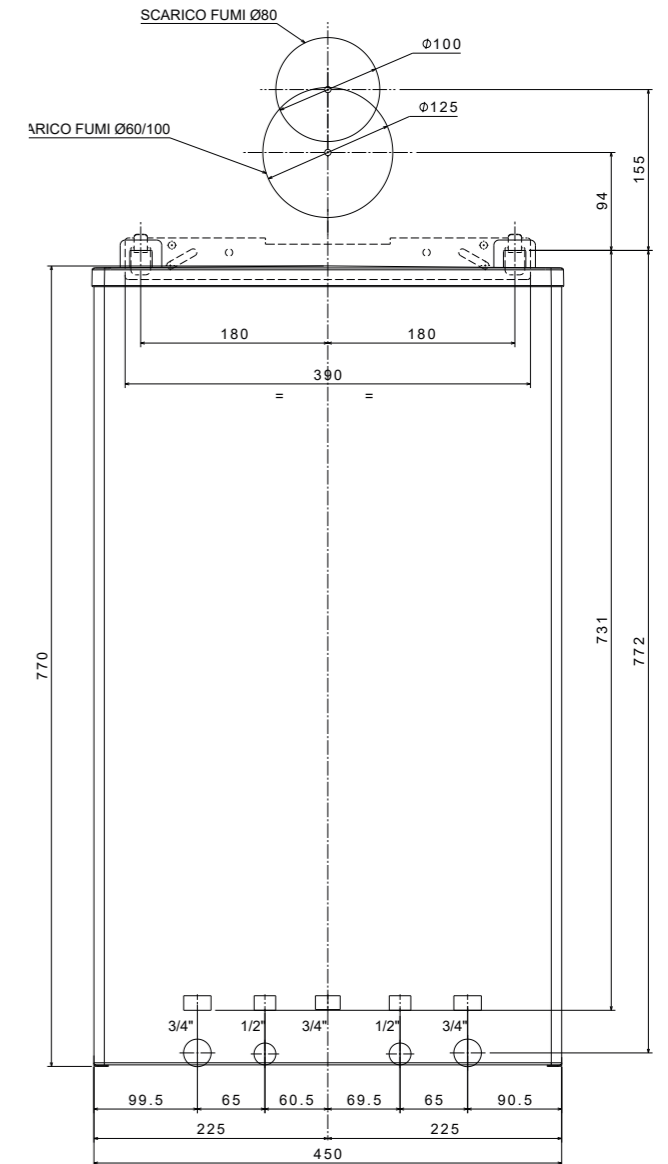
Fissaggio della caldaia a muro e allacciamenti idraulici
